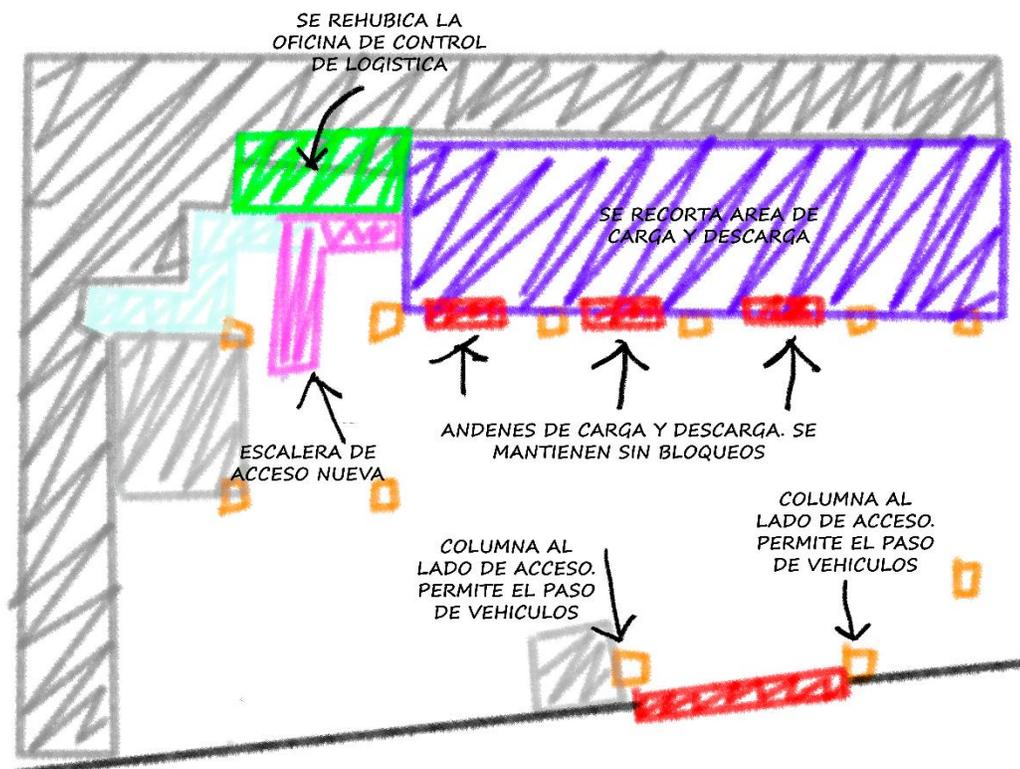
Croquis de propuesta de reordenamiento en planta baja [Croquis] Elaboración propia. (2023) CDMX
